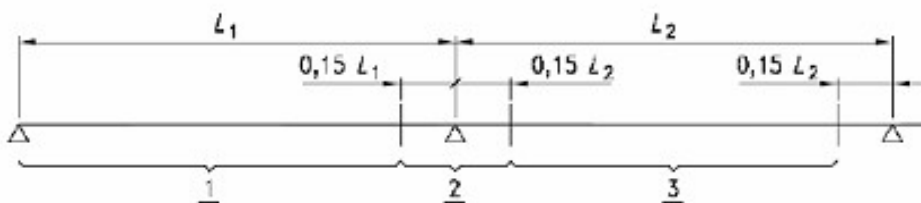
Aree dove si considerano la sezione di mezzeria o la sezione sull'appoggio
